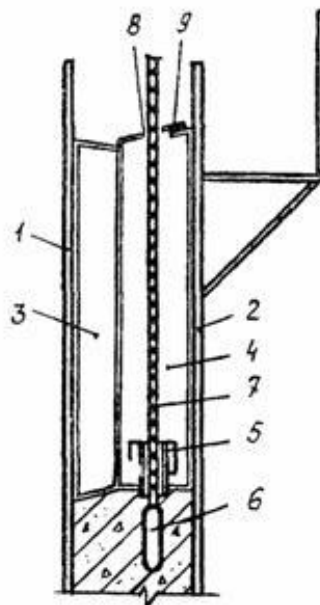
Схема уплотнения бетонной смеси под оконным проемобразователем:
